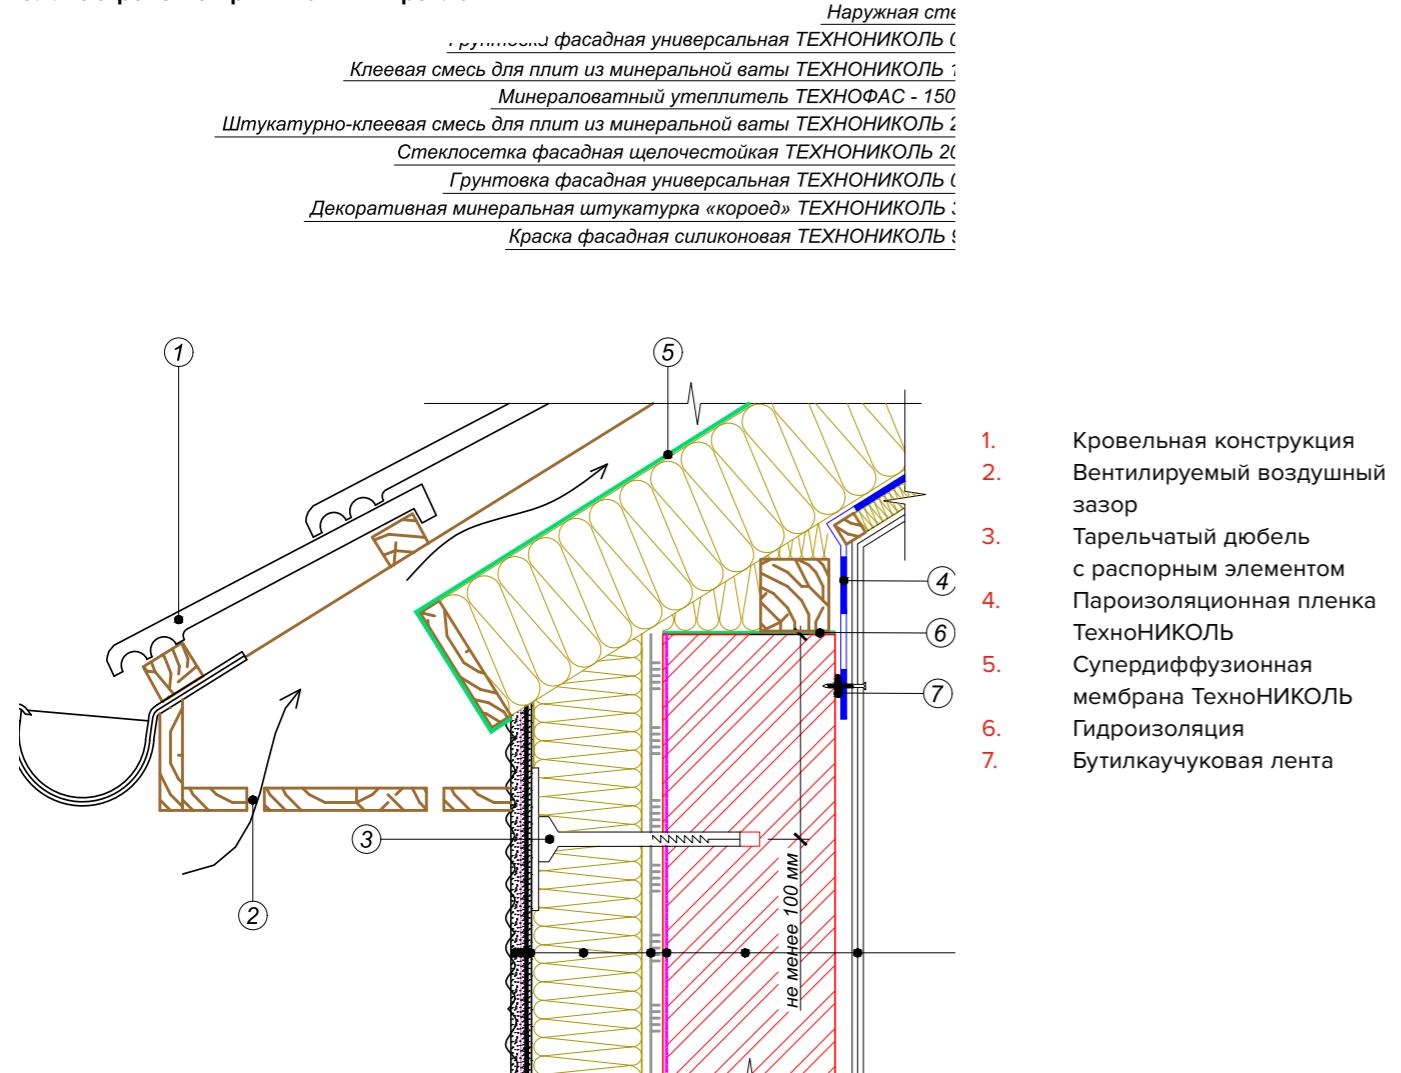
Примыкание системы к вентилируемой скатной кровле
